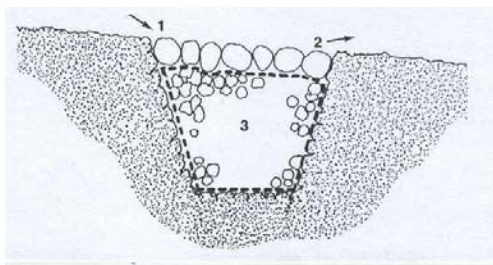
1.- Alimentación superficial, 2.- Rebase, 3.- Relleno.
